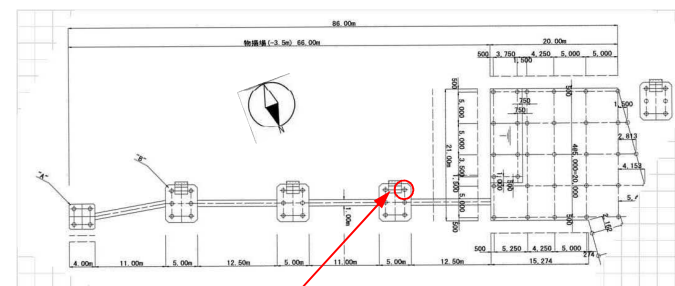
搬出入施設・車両乗降部 平面・断面図 (下部工：海水面より下)
